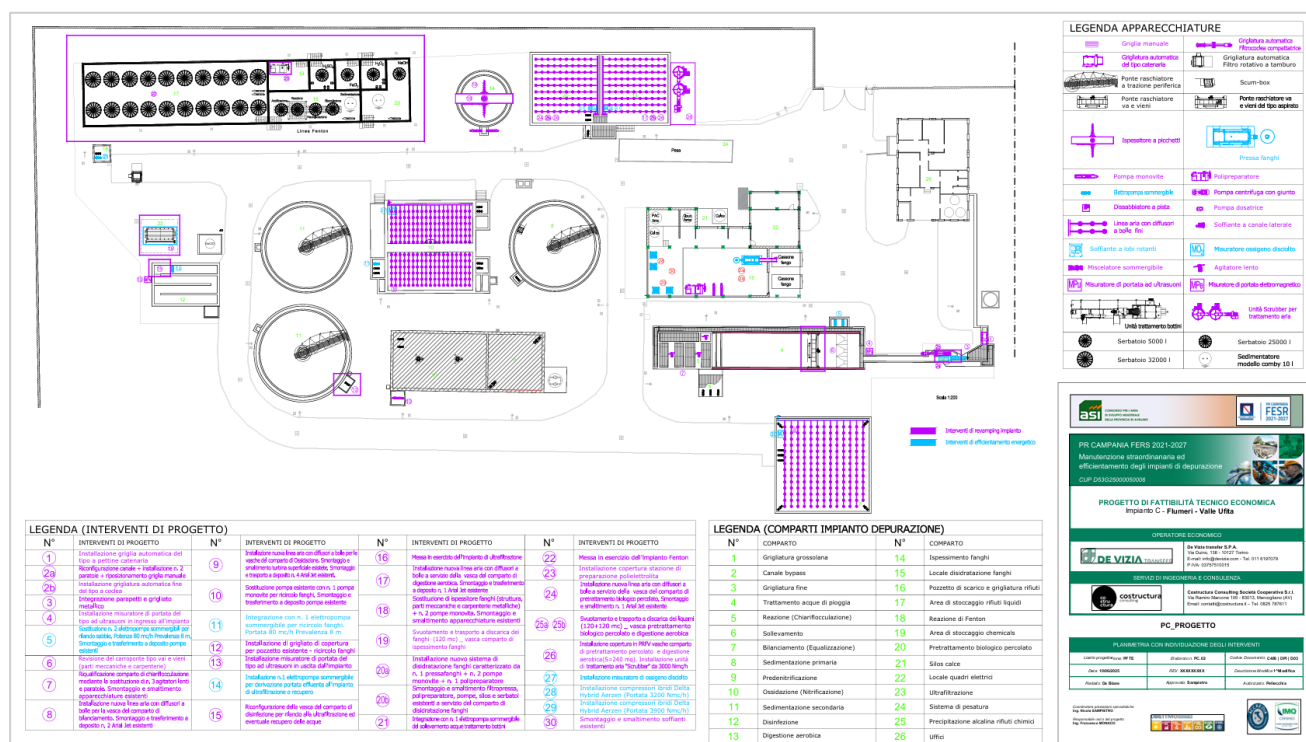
Tavola progetto PPC.02_Planimetria con individuazione degli interventi impiantistici
